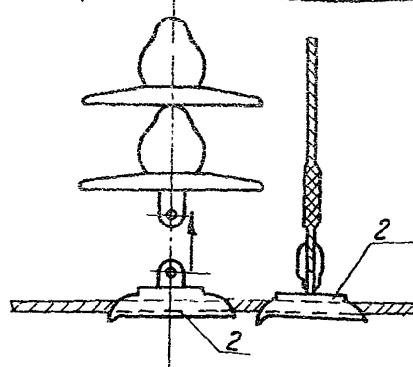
Узел „А“ Крепление монтажной лестницы и монтажного блока на тросе при перекладке проводов
